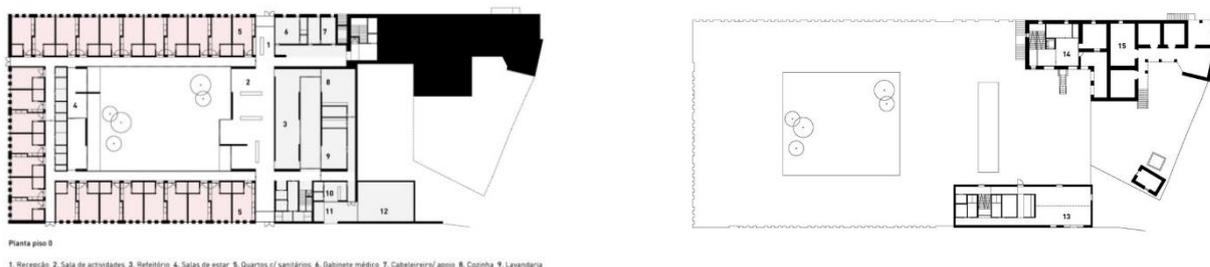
Planta baixa pavimento 0 e 1– Archdaily, 2023.
